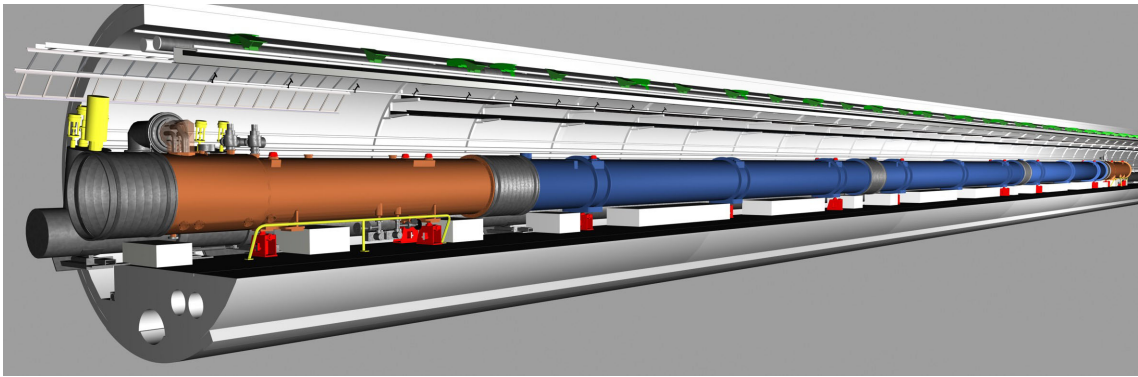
Tunnel R1900 : Coupe type dans le plan d'une liaison cryogénique.
